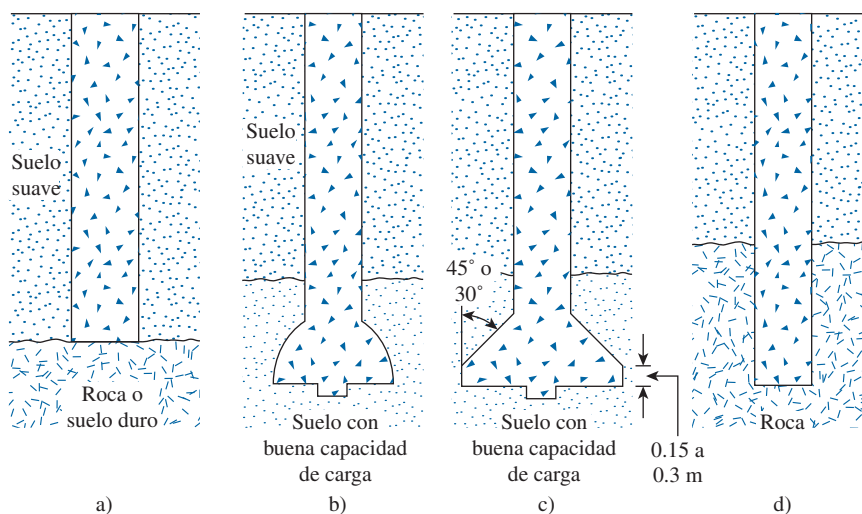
Tipos de pilas perforadas: a) pila recta; b) y c) pila acampanada; d) pila recta empotrada en roca.
